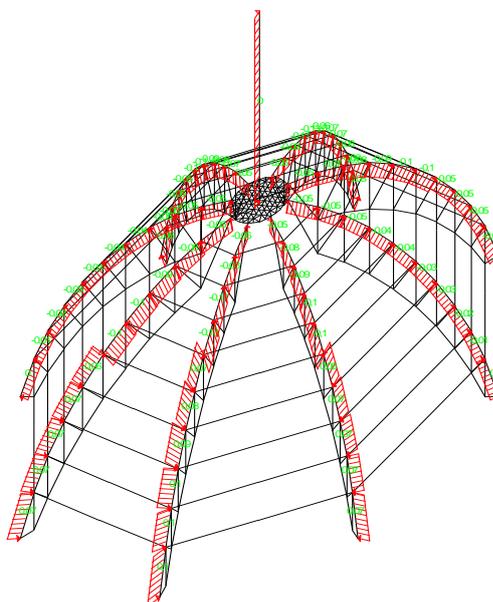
Расчетная схема с указанием ветровой нагрузки
